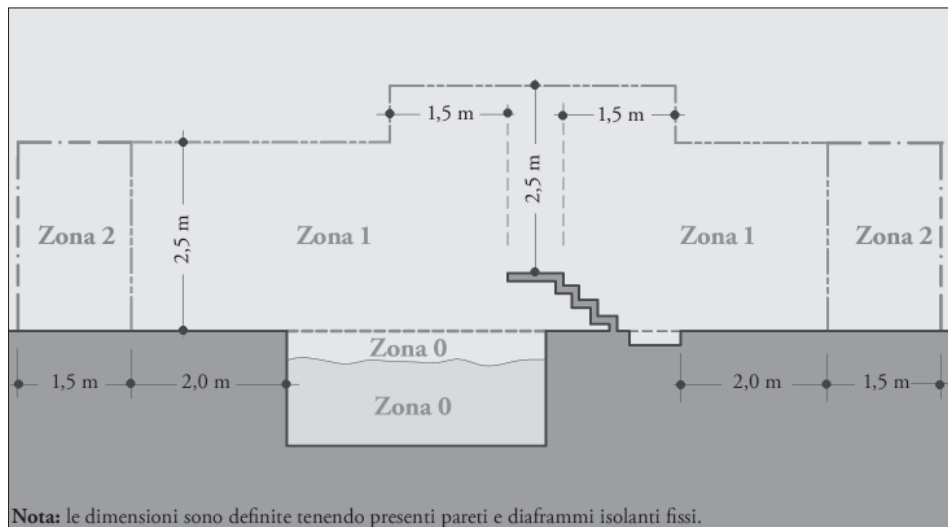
Dimensioni delle zone delle piscine incassate e dei relativi pediluvii di accesso (sezione verticale). (ridisegnato da: Norma CEI 64-8/7:2007).
